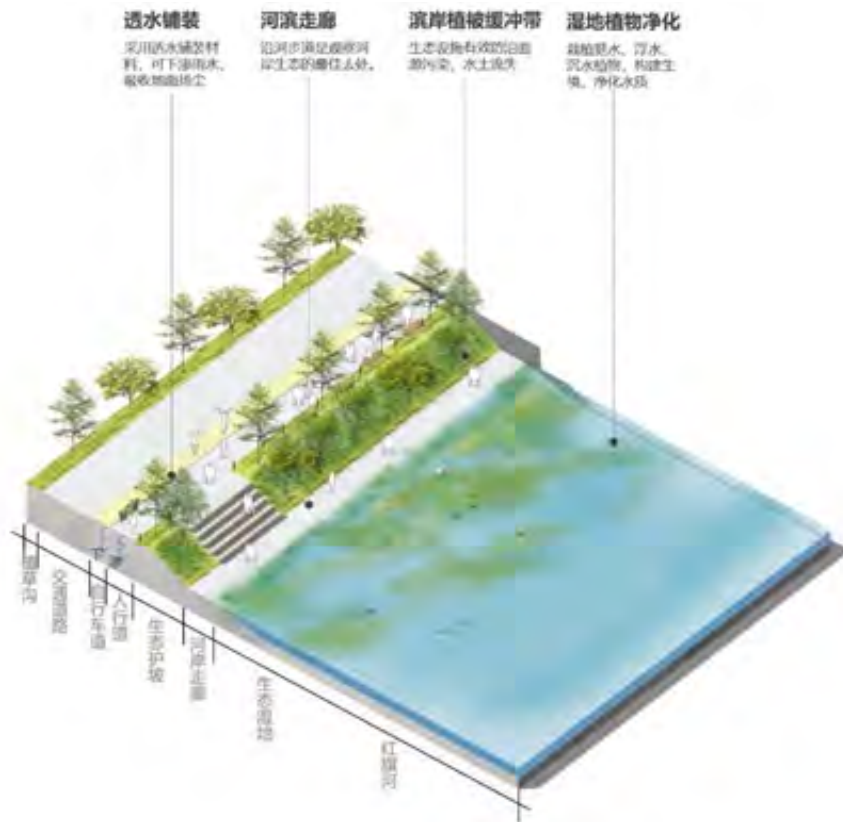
红旗河三板水乡甜蜜时光节点典型剖面图
